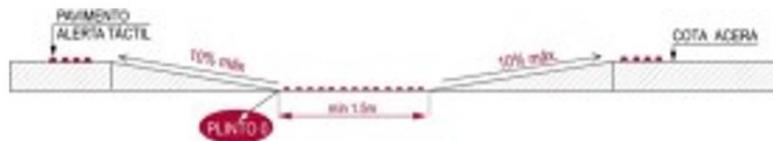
Cruce peatonal rebajado en una vereda de ancho inferior a 1,2m. La vereda baja en toda su anchura hasta alcanzar la cota de la calzada.
